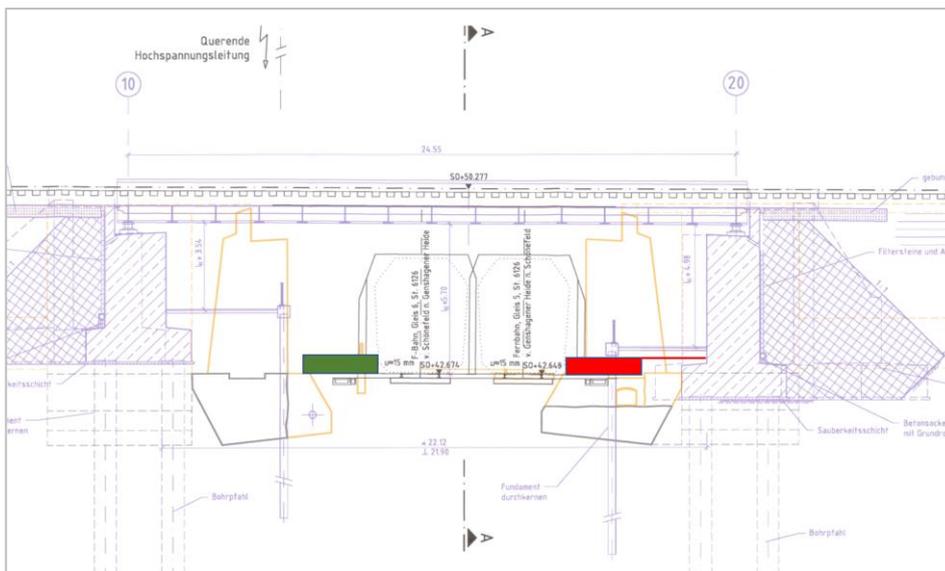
Auszug aus dem Lageplan des Kreuzungsbauwerks (Genehmigungsplanung) mit Darstellung von Bahnsteiglagen (grün = Bauraum vorhanden, rot = Bauraum nicht vorhanden)
